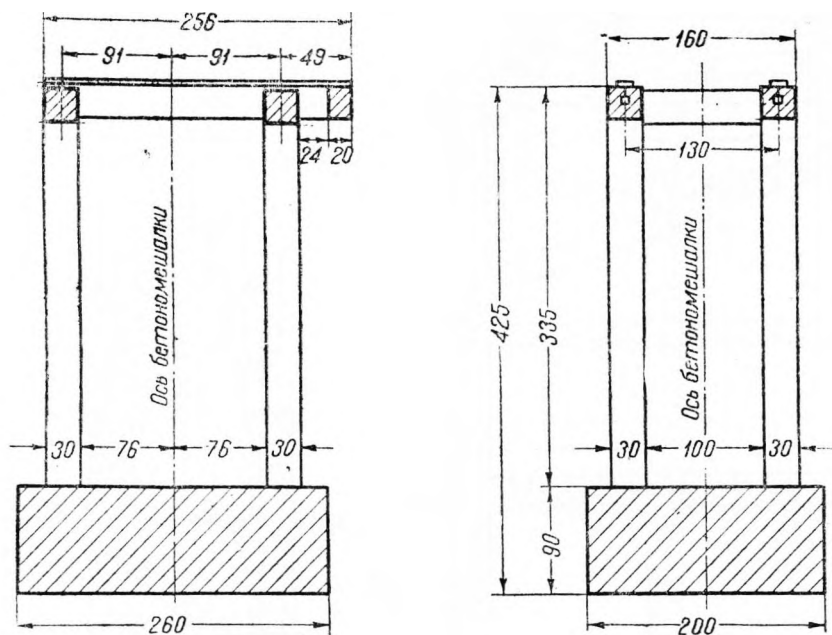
Ряжевый фундамент под 500-л бетономешалку
